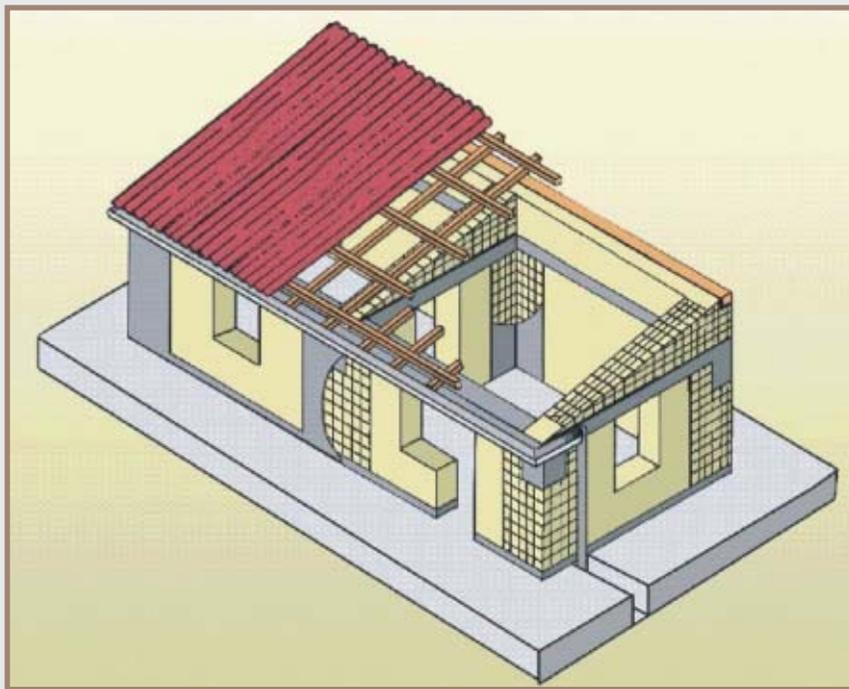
Modelo antisísmico aplicado a la reconstrucción de viviendas en Arequipa.
